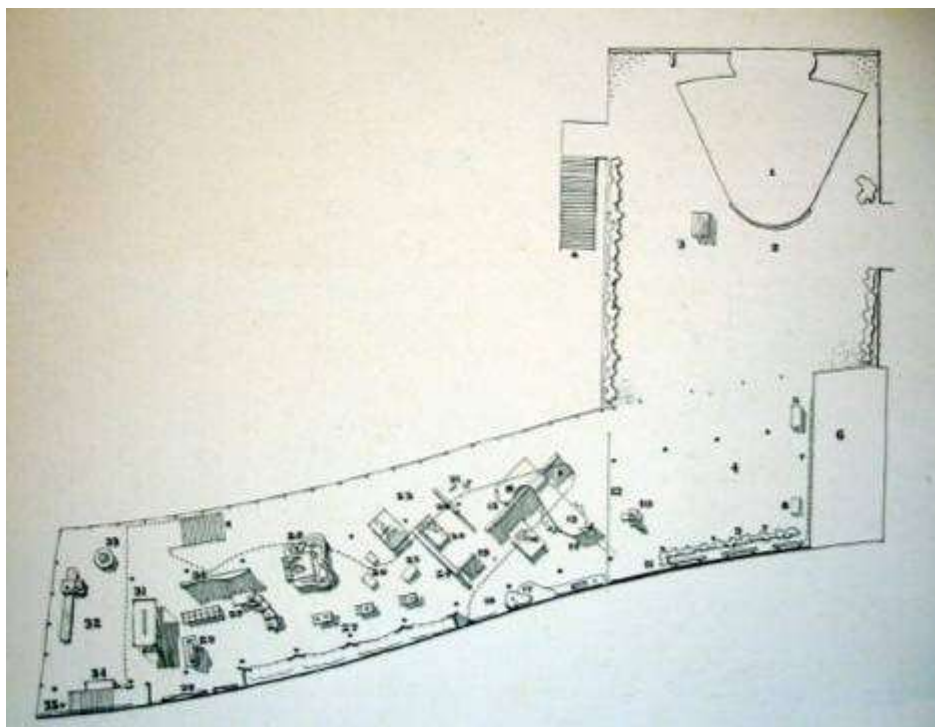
Planta do 1º Pavimento (Fonte: WORLD'S FAIR, 1939).
